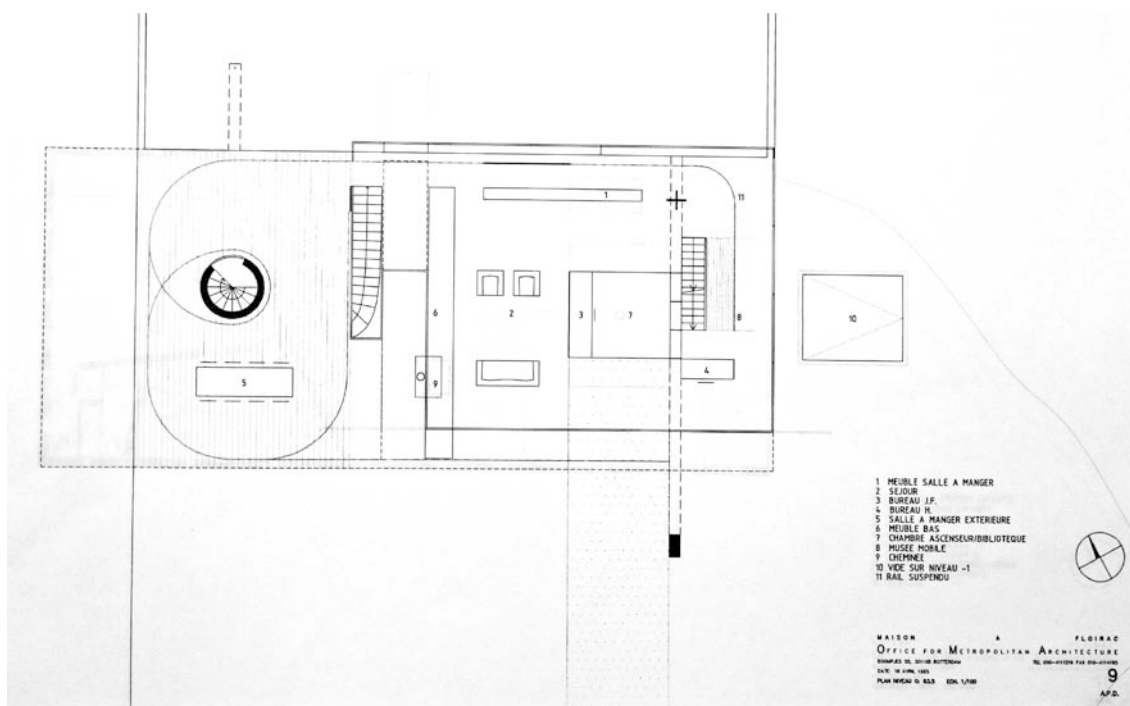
Planta 9 de un conjunto de planos fechados 18 abril 1995. Planta intermedia, carril de cortina.
